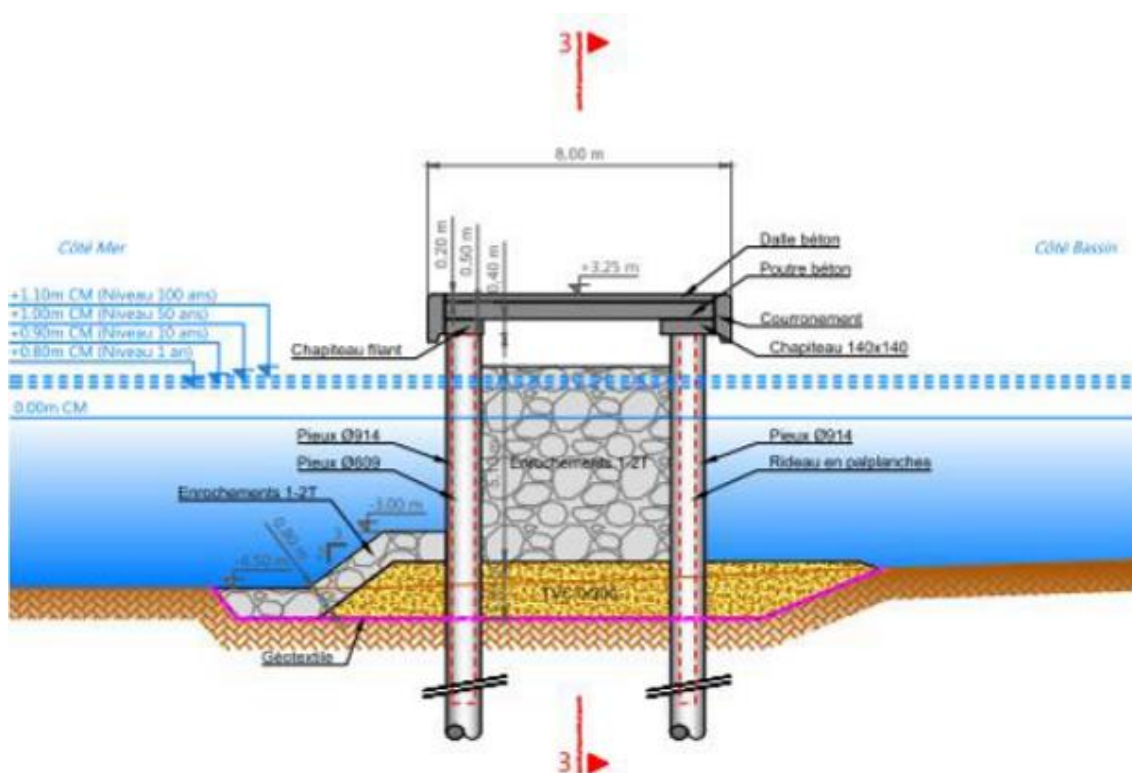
Coupe transversale du tenon de type amortissant mixte (pieux / enrochements)
